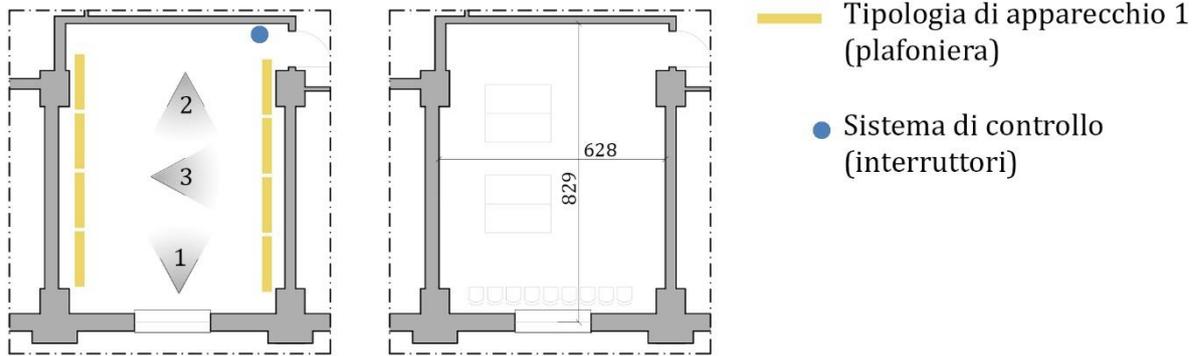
Piante in scala 1:200 con posizione degli apparecchi e degli interruttori, con ottico delle foto, posizione dei banchi e quote dell'aula sud-ovest del piano terra.
